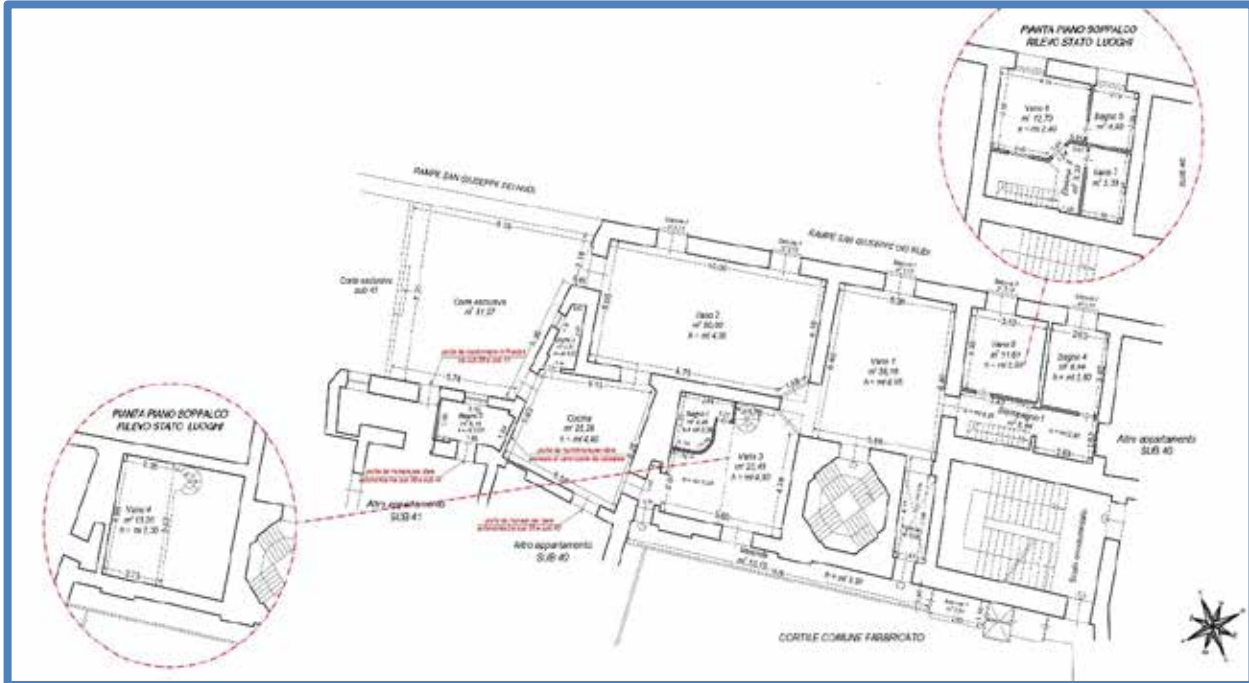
Planimetria del rilievo dello stato dei luoghi appartamento sub 38.
